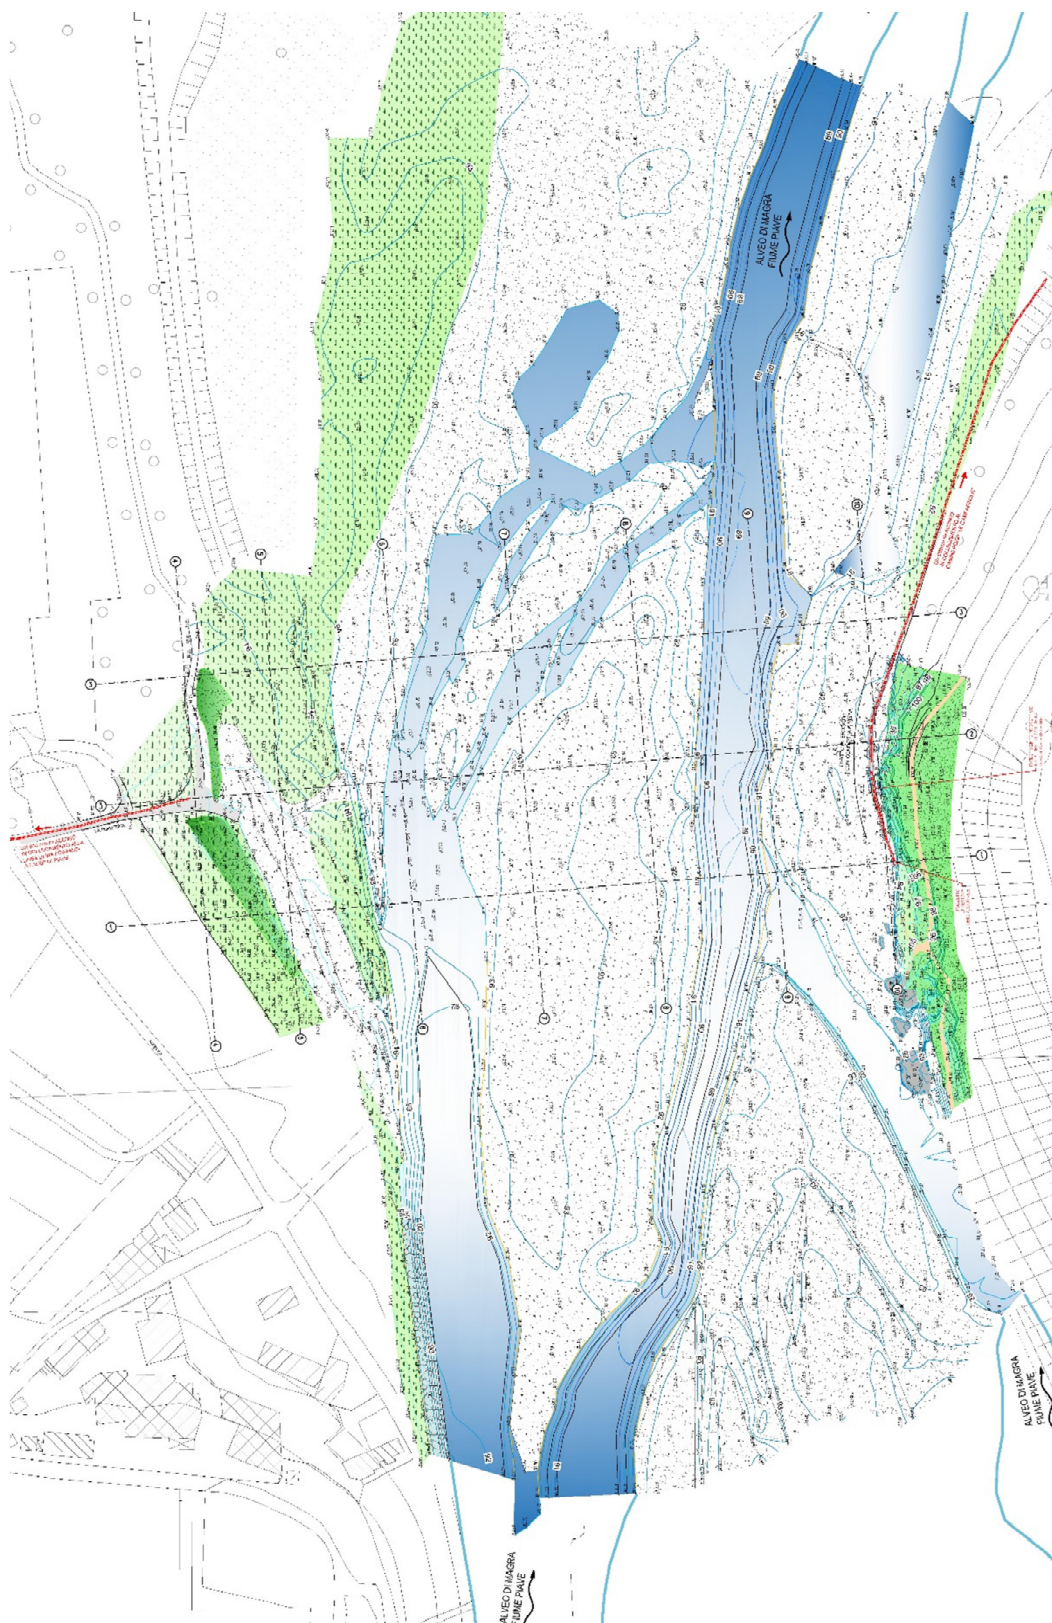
Restituzione del rilievo topografico e inserimento su ortofoto – riferimento 2016.
